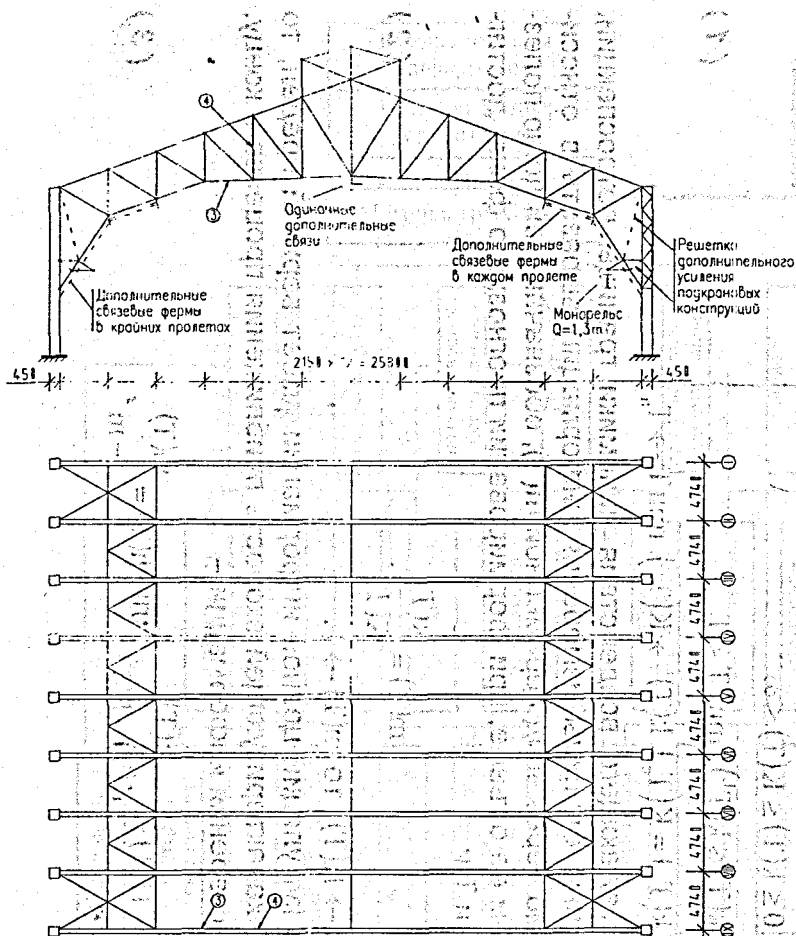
Схема решетки усиления подкрановых конструкций арочных ферм и план установки дополнительных связей по нижним поясам.
